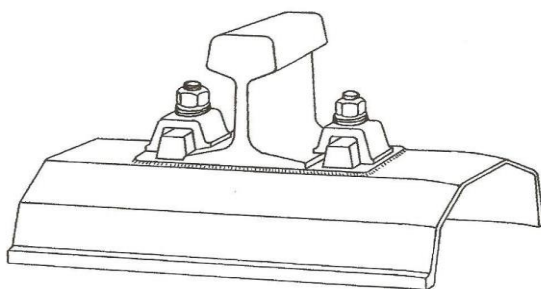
Fixação tipo GEO, com chapa soldada
